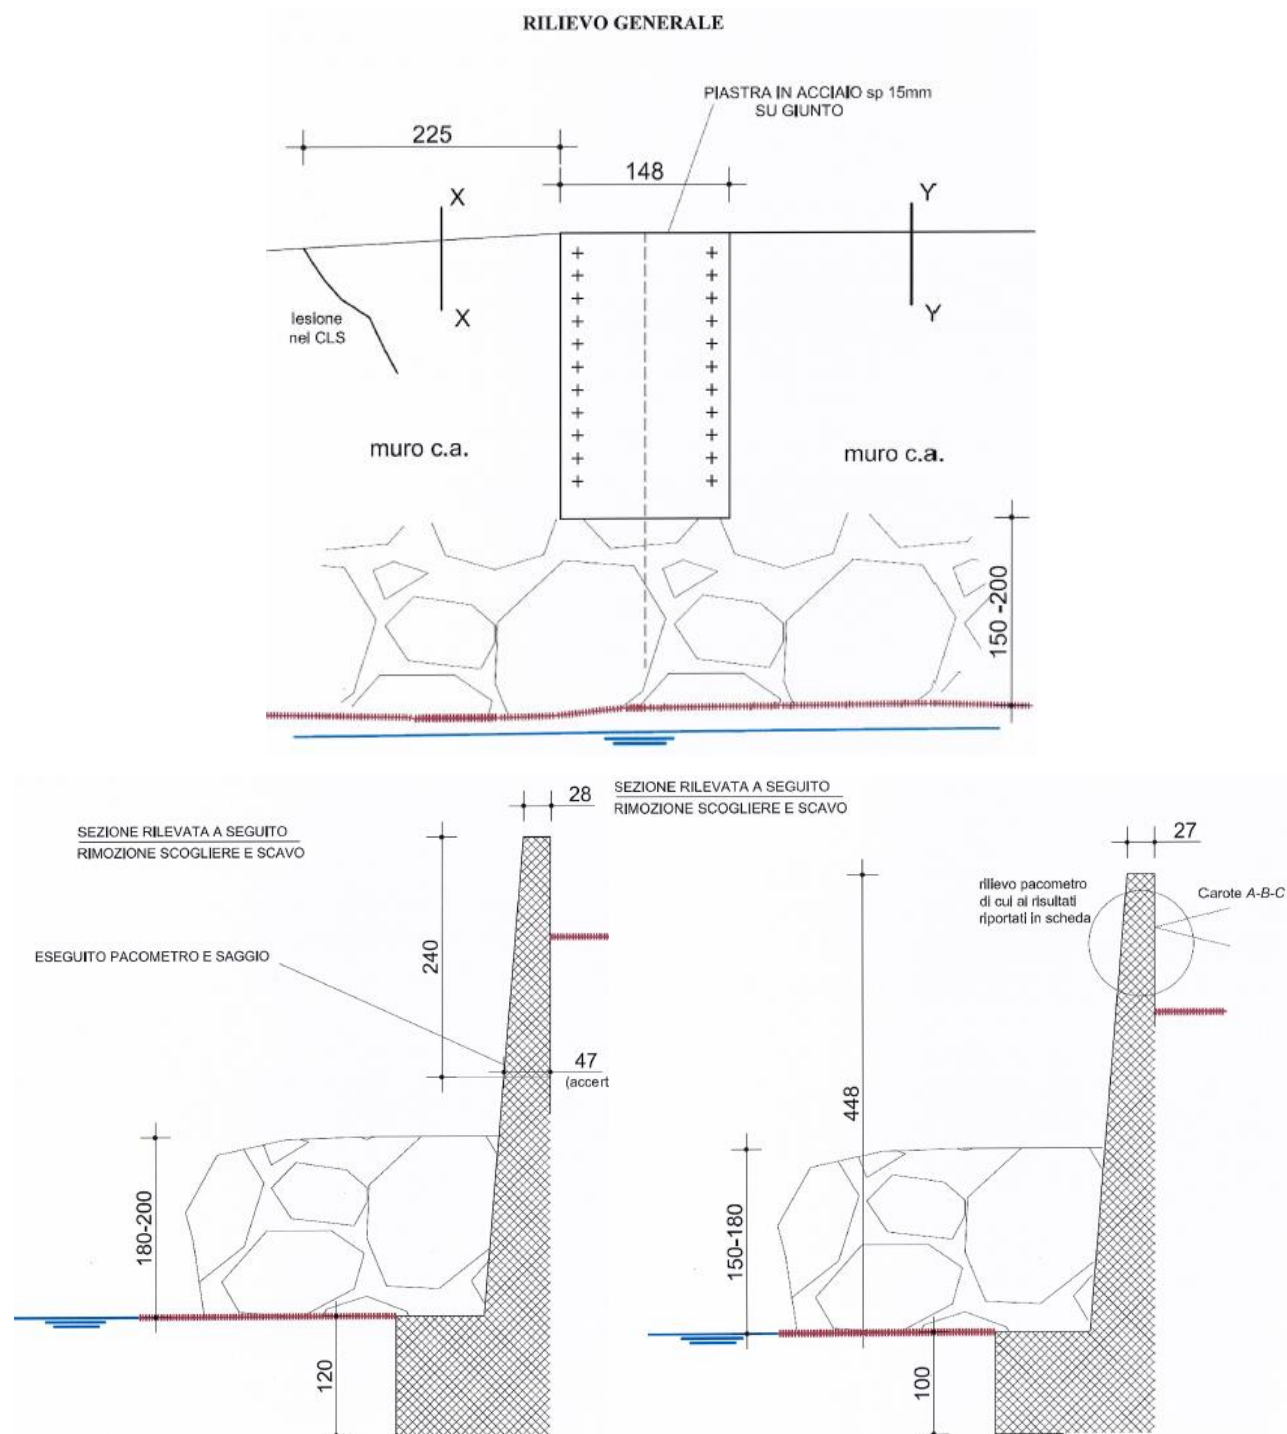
Sezione tipologica strutturale rilevata in sito
